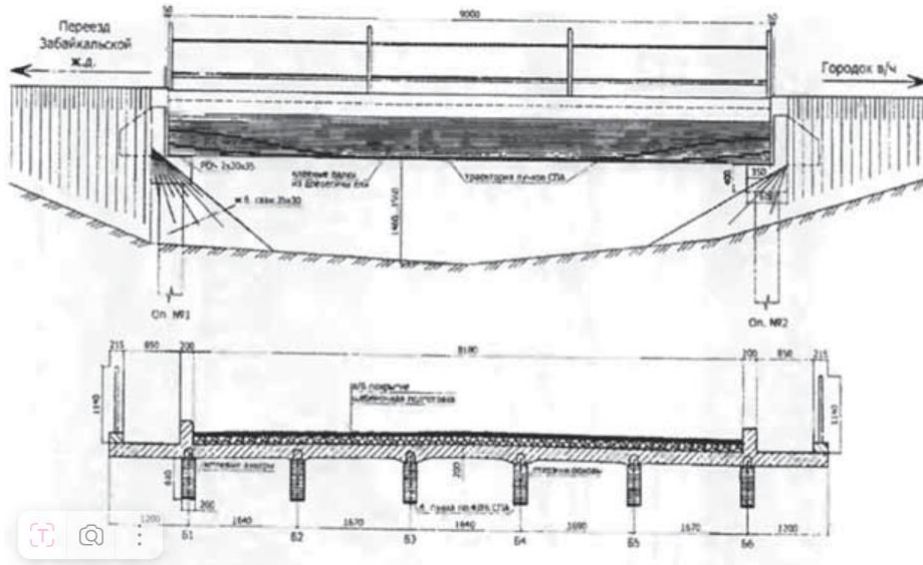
Конструктив дерево-железобетонного пролетного сооружения с балками из клееной древесины, предварительно напряженными стеклопластиковой арматурой
